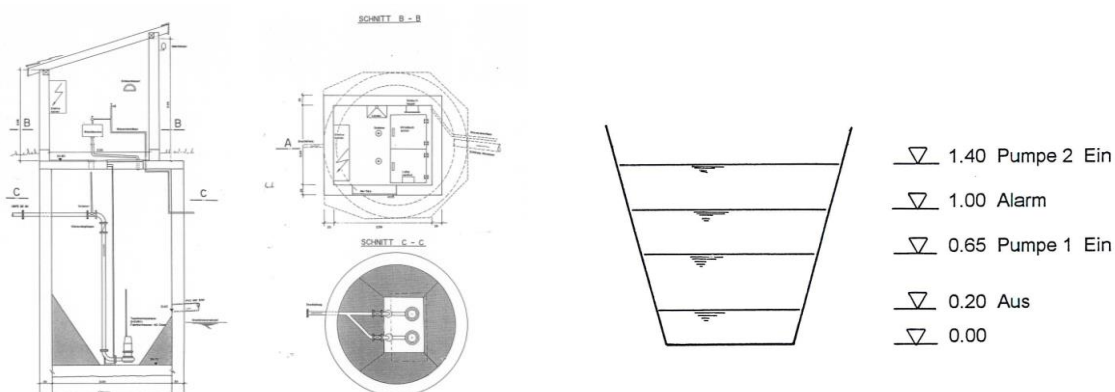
Planschnitte und Lage der Schalthiveaus
